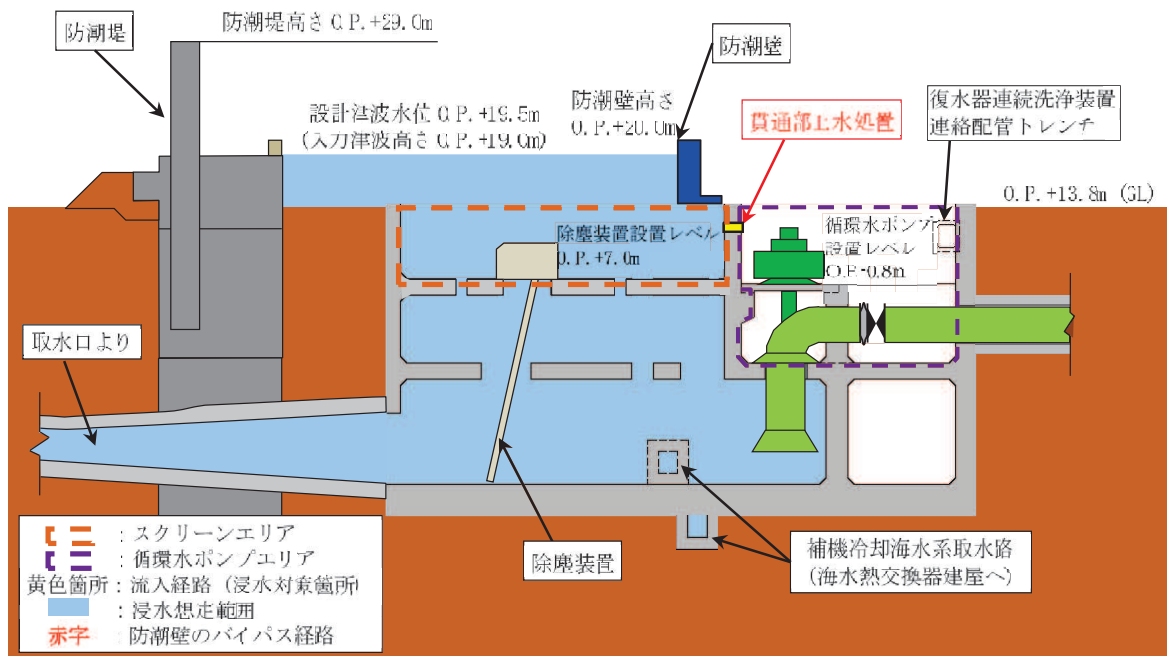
(2) 第 3 号機 海水ポンプ室 流入対策配置図 (A-A 断面図)
